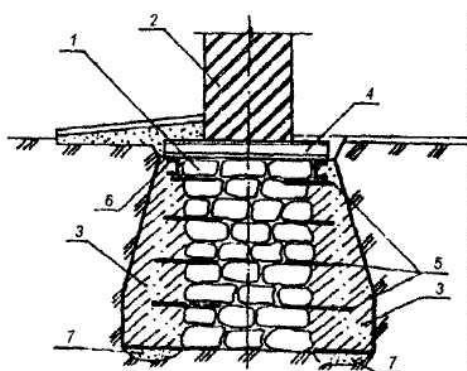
Уширение подошвы ленточного бутового фундамента (устройство приливов из бетона)
